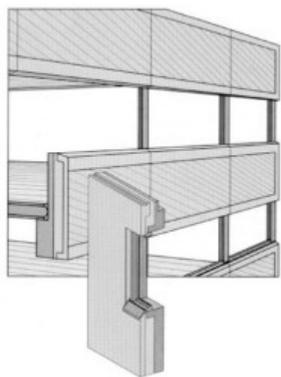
Схематическая конструкция стеновой панели / Schematic construction of a wall panel
